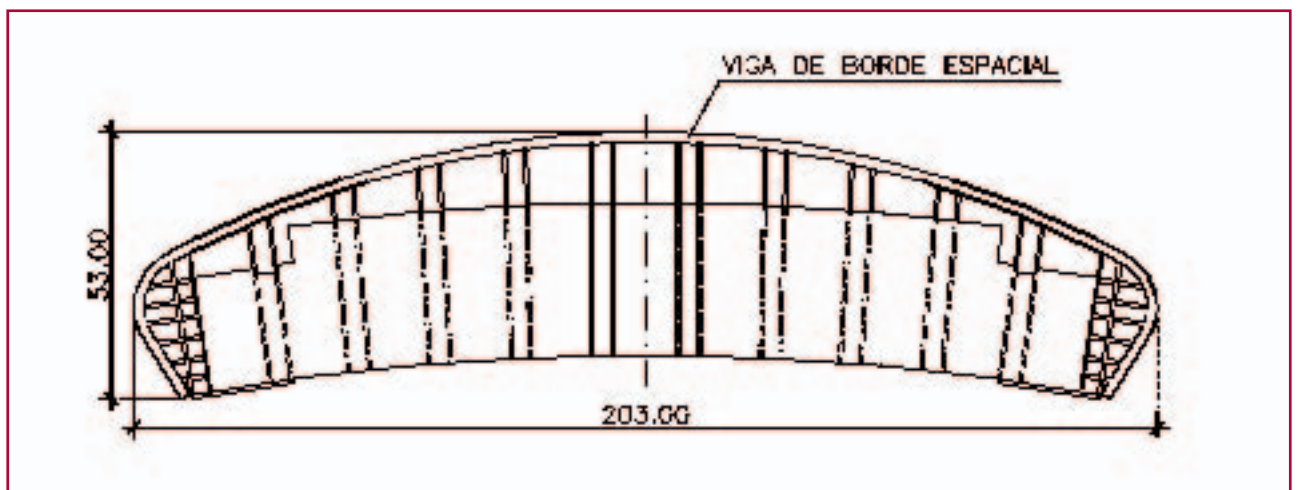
Planta del graderío superior incluyendo la viga de borde espacial curva.
